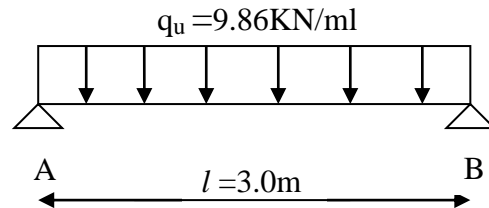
schéma statique de la poutre de chaînage à l'ELU.
